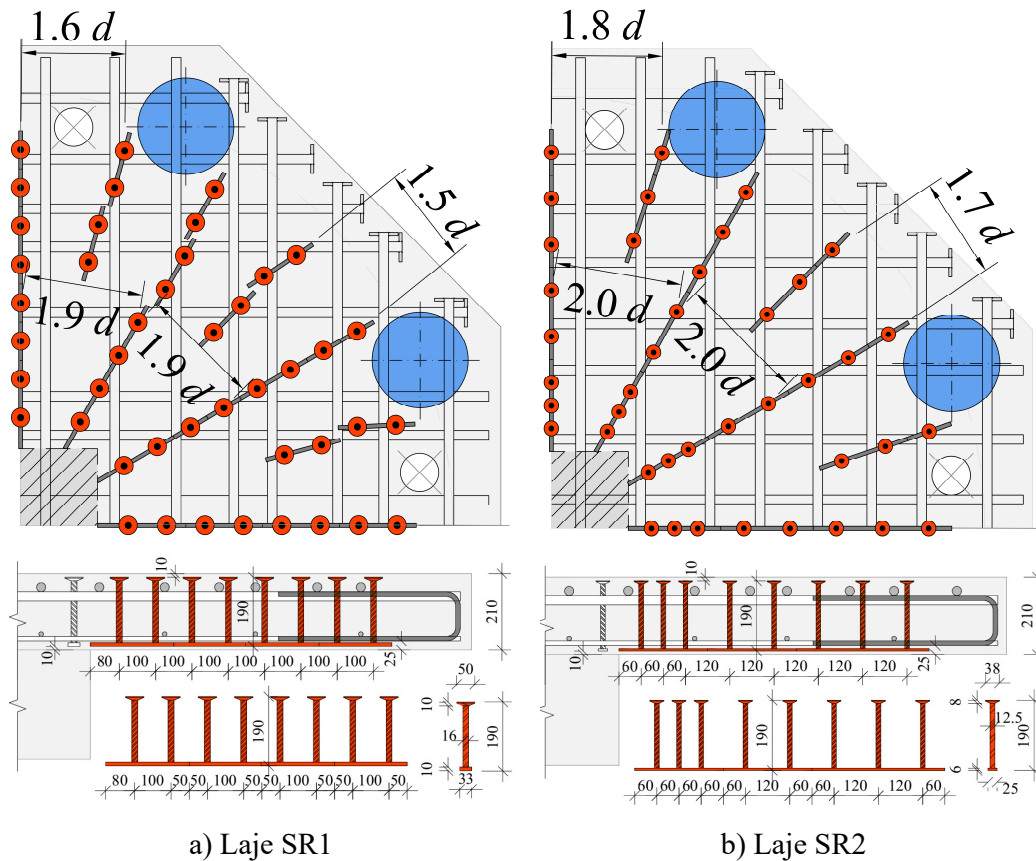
Detalhe da armadura de cisalhamento das lajes com *stud rail*.
